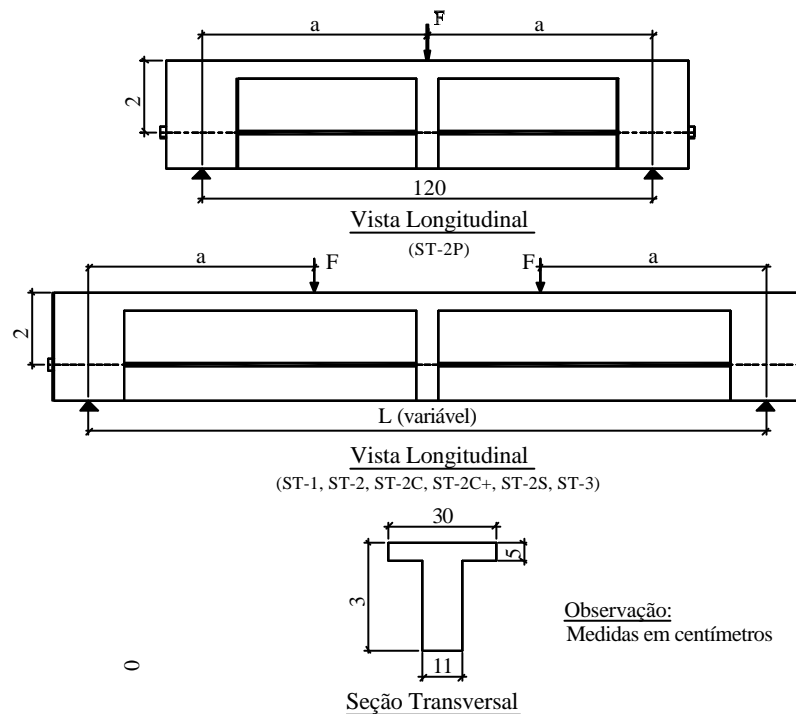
Vistas longitudinais e seção transversal das vigas ensaiadas por TAN & NG (1998)
